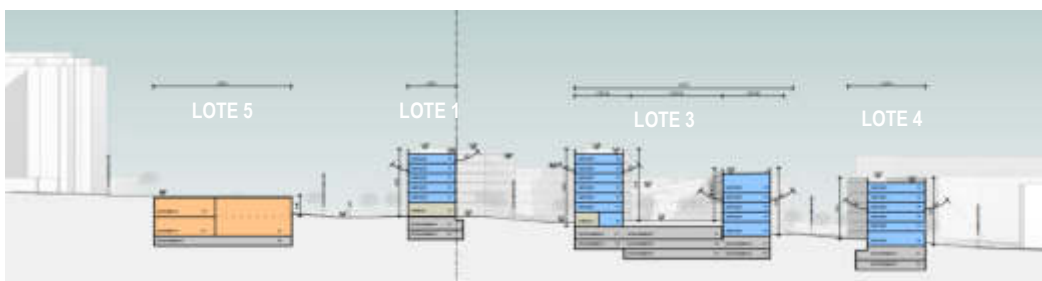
Perfil C da proposta do Loteamento, lote 1, 3, 4 e 5.
